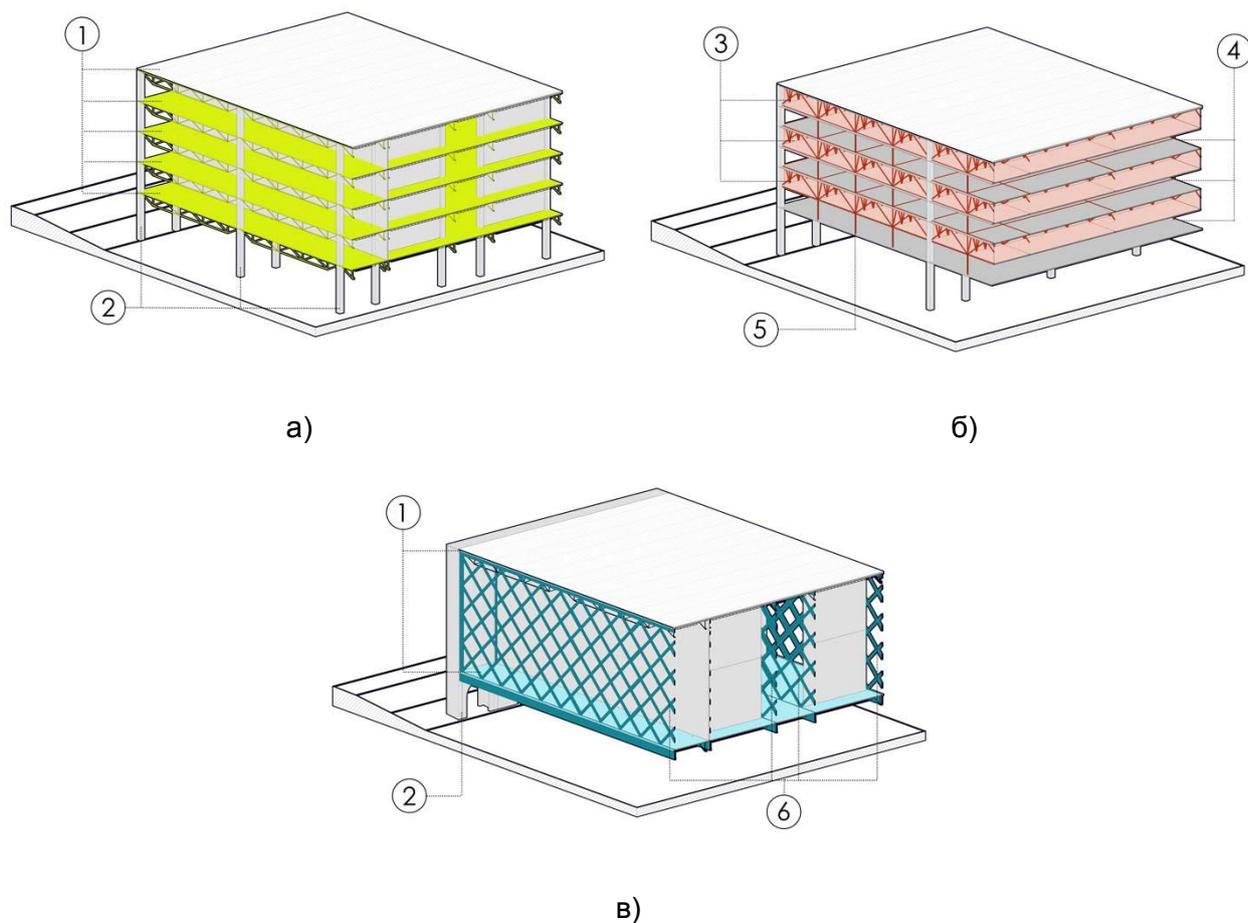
Конструктивные решения зданий-мостов: а) конструктивная схема малопролетного здания-моста; б) конструктивная схема среднепролетного здания-моста; в) конструктивная схема большепролетного здания-моста (1 – сталежелезобетонное перекрытие; 2 – вертикальная опора; 3 – «несущий этаж»; 4 – этаж со свободной планировкой; 5 – подвес; 6 – многоярусная ферма)
